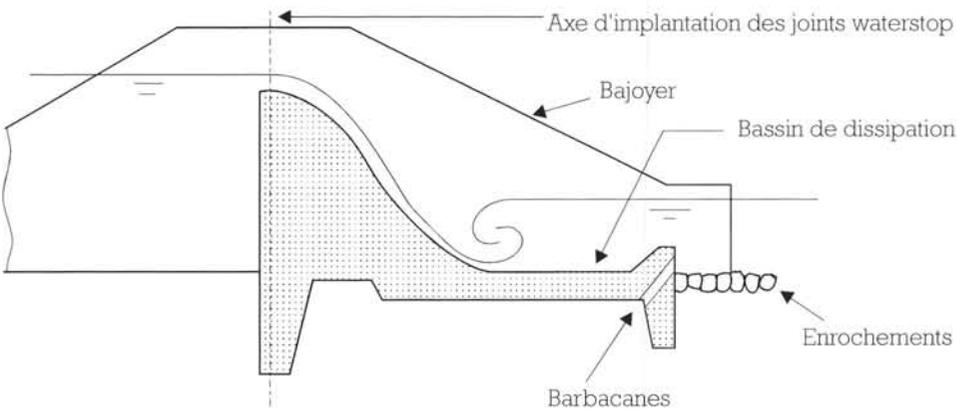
Schéma d'un déversoir-poids en béton à profil Craeger.
